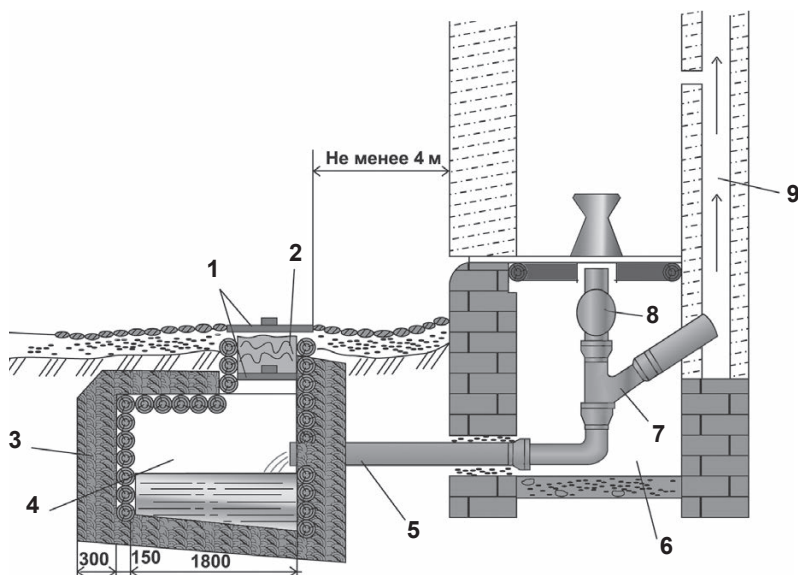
Конструкция люфтклозета: 1 — крышка выгреб размером 60×70 см; 2 — утеплитель; 3 — глиняный замок; 4 — выгреб из дерева; 5 — труба диаметром 10 см; 6 — прямой; 7 — вытяжная труба; 8 — ревизия; 9 — дымоход
